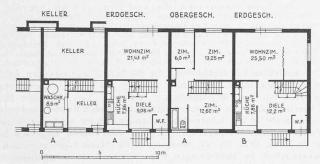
Gruppe D der Baugenossenschaft Theresiengarten. Grundrisse 1:300. A Eingebautes Einfamilienhaus, B Eckbau. Architekt Walter Bosshart, Zürich.
